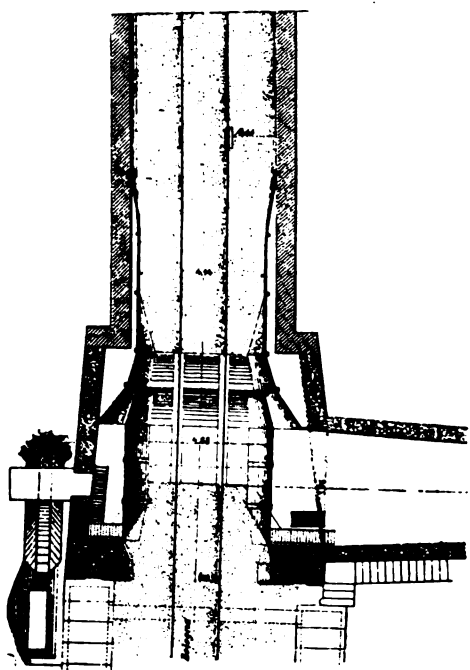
Officina per la ventilazione della galleria di Pracchia - Sezione planimetrica.
